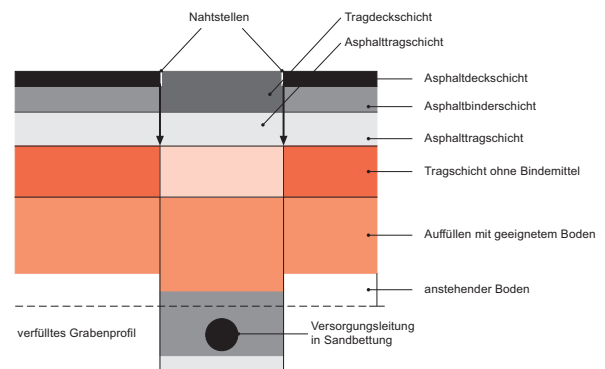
Straßenoberbauprofil in verfülltem Leitungsgraben mit einsickerndem Oberflächenwasser
